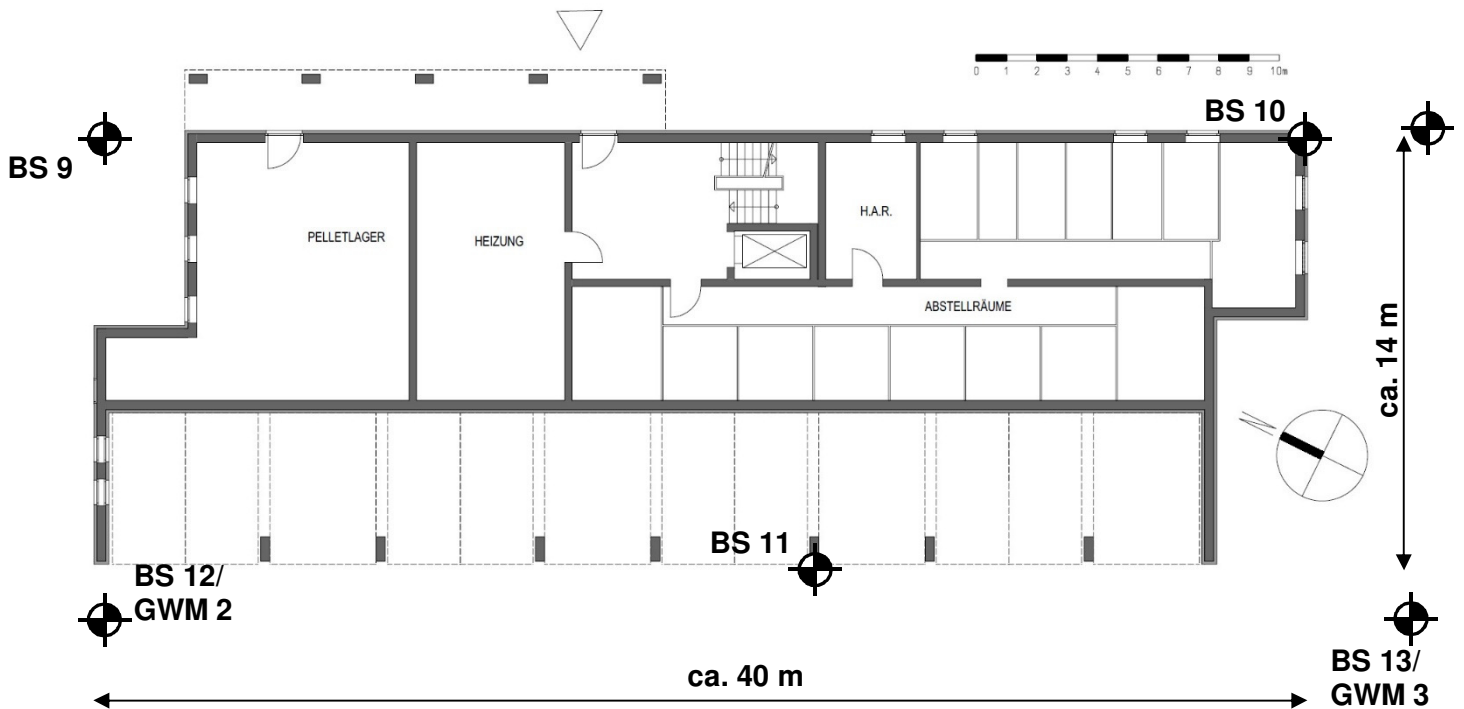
Erdgeschossgrundriss Haus 4, M 1:250
